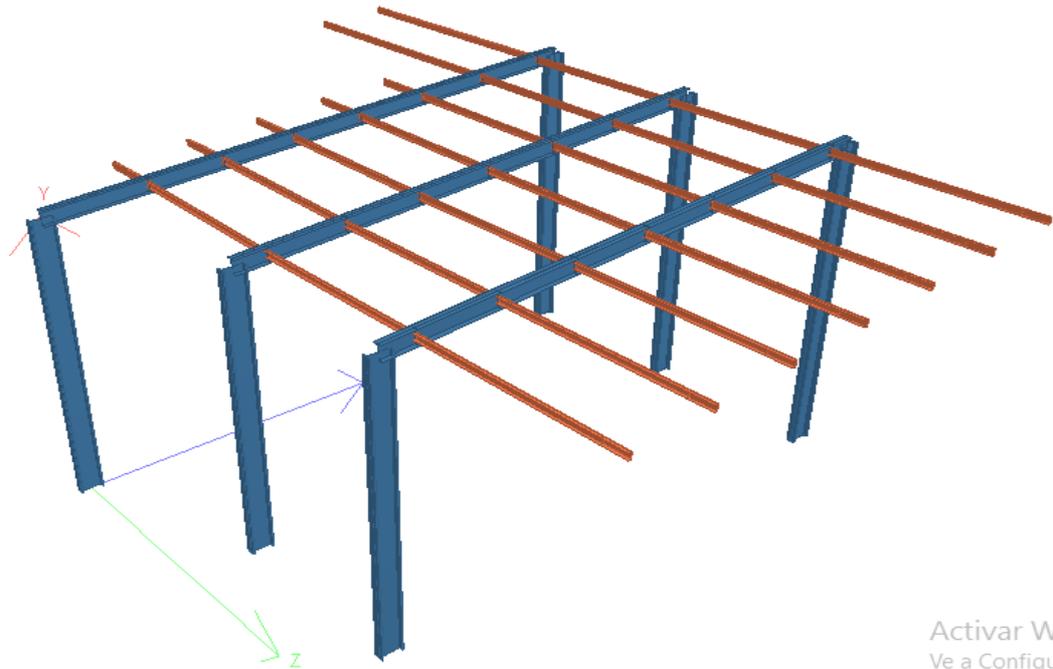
Vista de la estructura metálica en 3D del software STAAD Pro. Fuente: Proyecto "Panadería Dulcería "Empresa IDEAR de Cienfuegos
